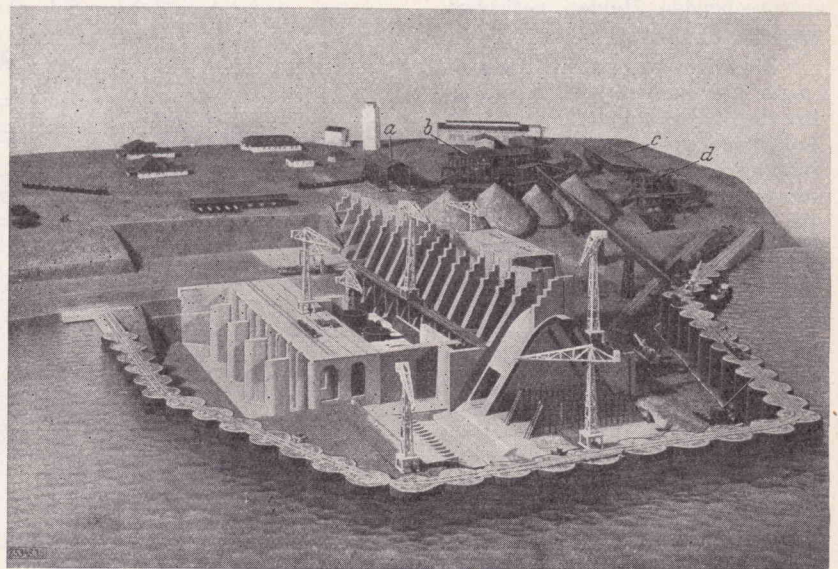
Modellaufnahme der Baustelle am Rio Negro mit der Betonaufbereitungsanlage.
